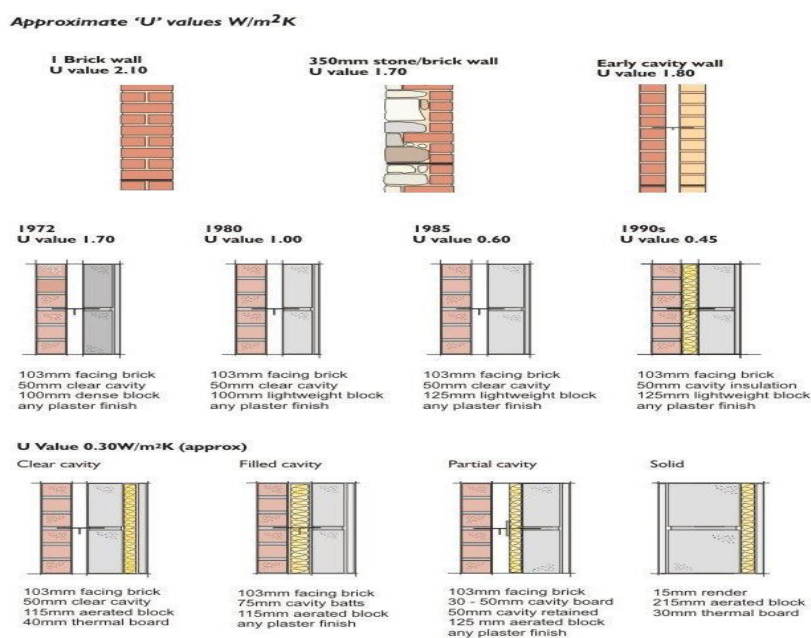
Развитие требований по теплоизоляции наружных стен жилых зданий[11]
